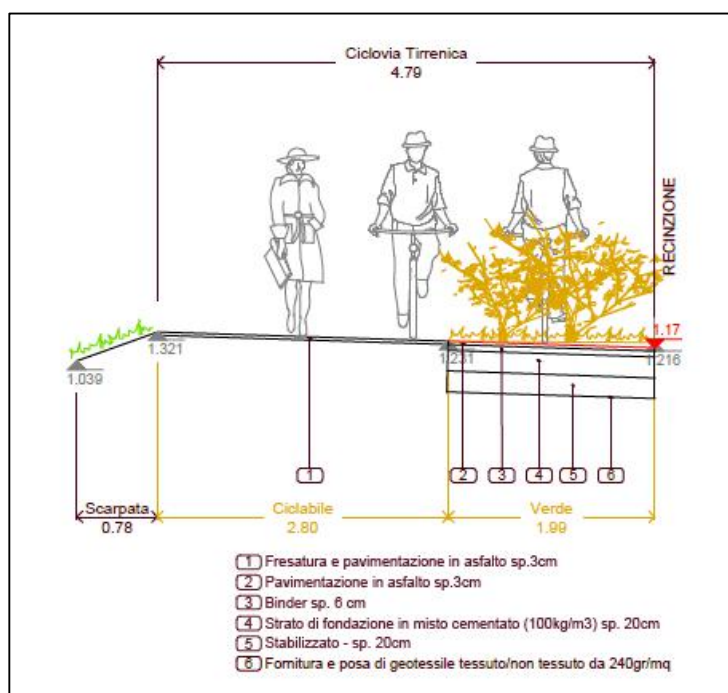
Sezione 15 di progetto trasversale SP delle Collacchie
